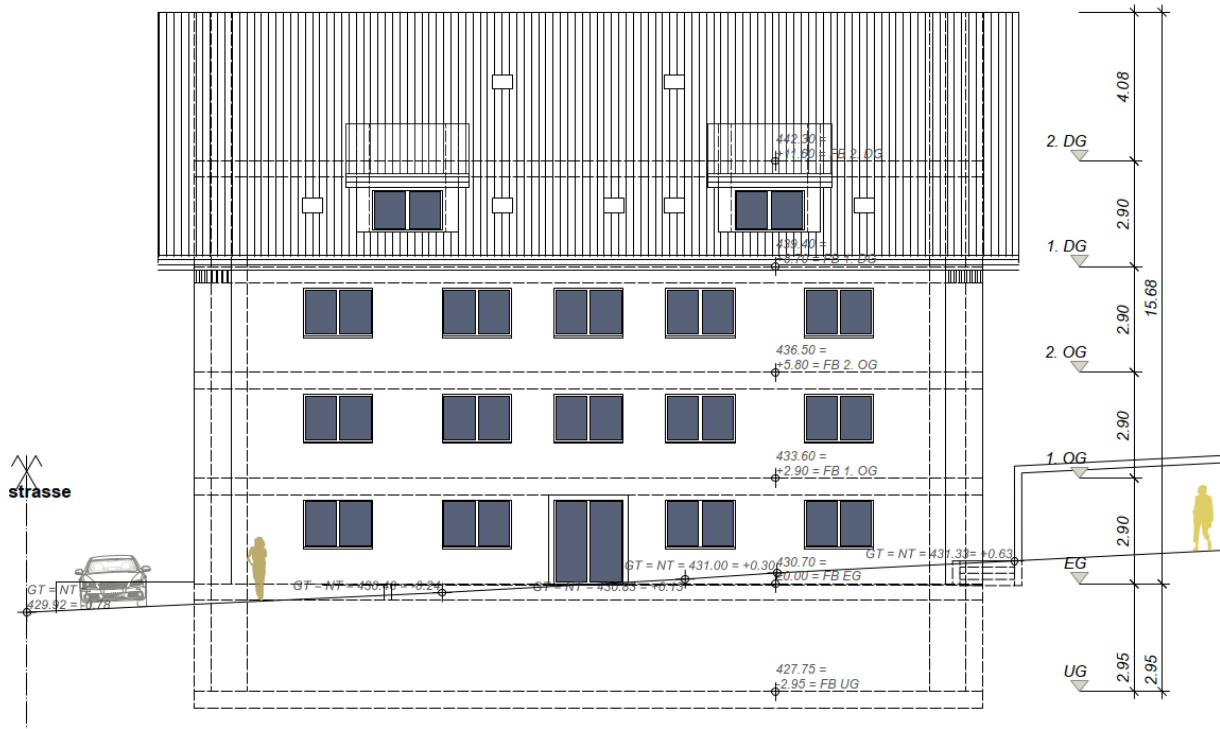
Ausschnitt Richtprojekt: Fassadengestaltung Nord-Ost-Fassade
